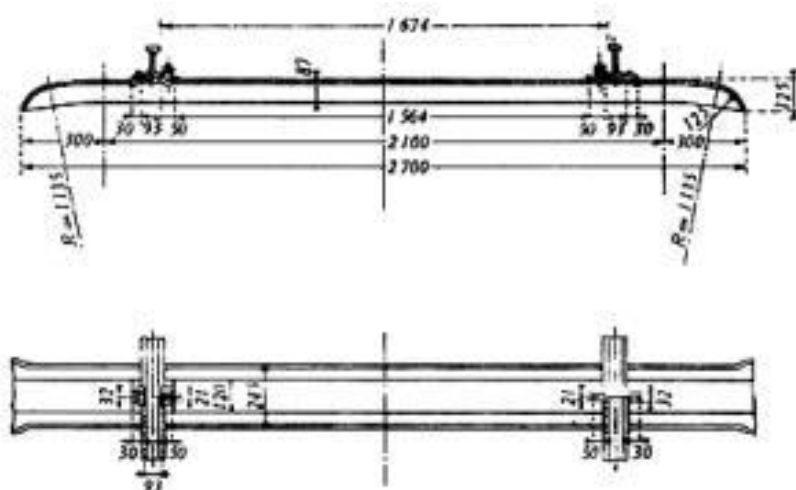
SECCIÓN LONGITUDINAL Y PLANTA DE UN DURMIENTE METÁLICO
